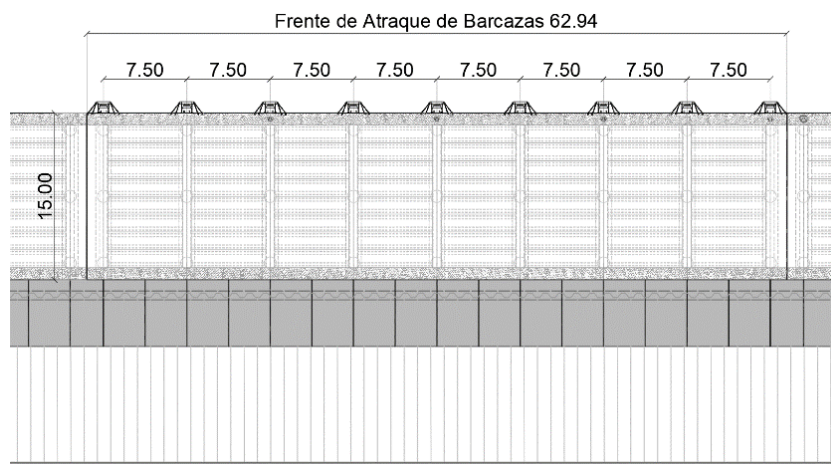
Planta de Módulo Típico del Muelle de barcas
